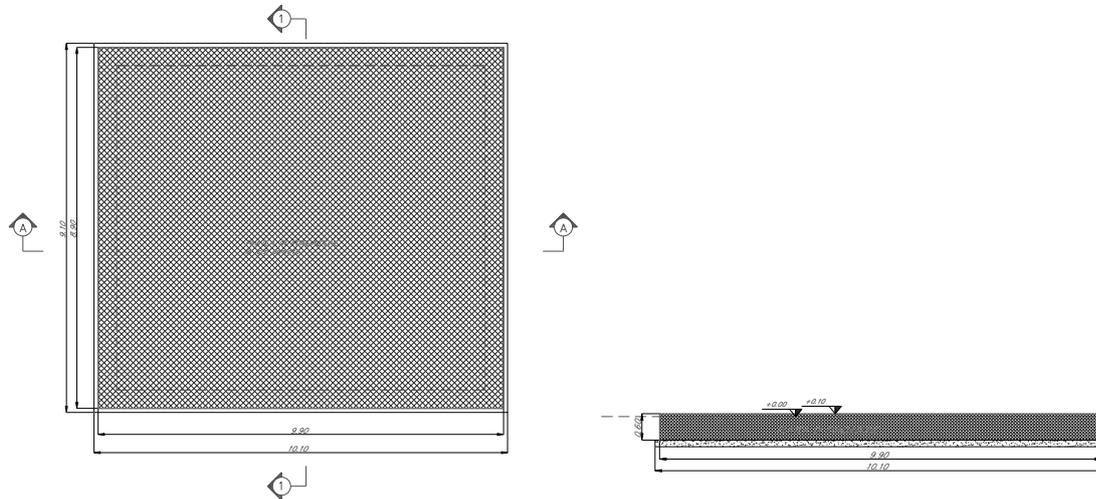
Pianta e sezione della platea di fondazione al km 5+518,820
